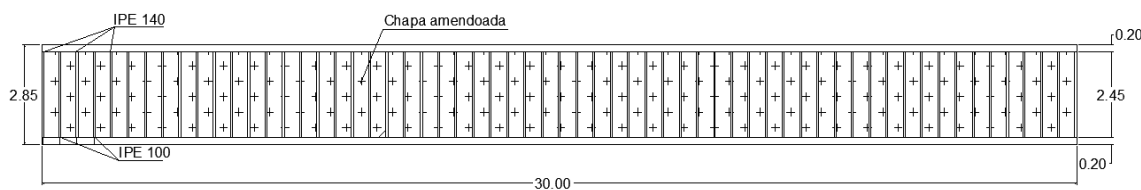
Vista inferior do tabuleiro da ponte pedonal
